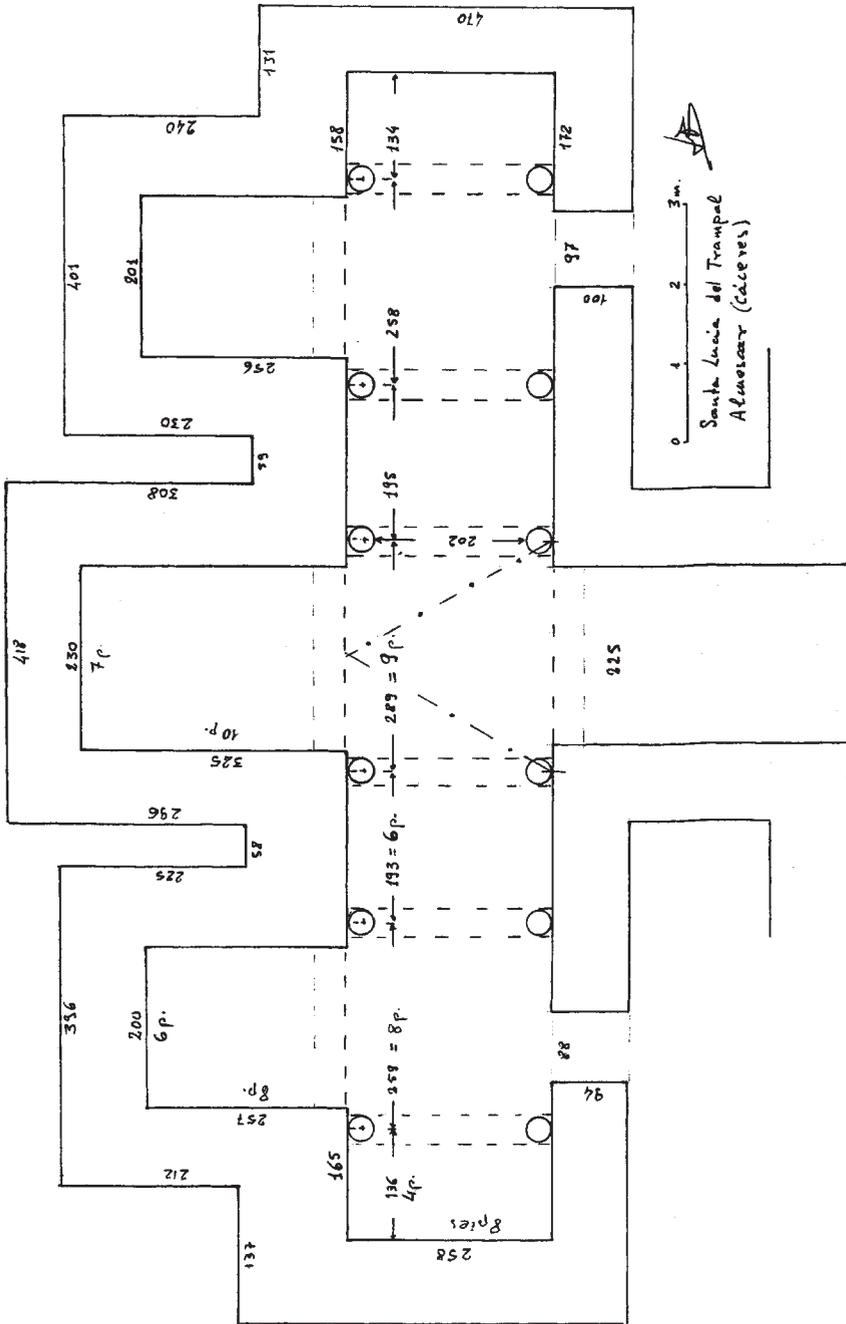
Santa Lucía del Trampal. Alzado y planta. Medidas en centímetros y en pies.
